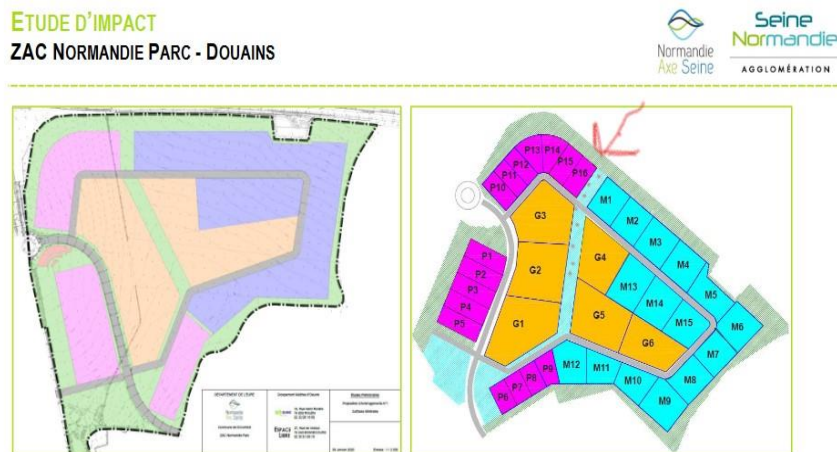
Proposition de plan masse avec découpage parcellaire (Source : Espace Libre/SUEZ Consulting – janvier 2020)
